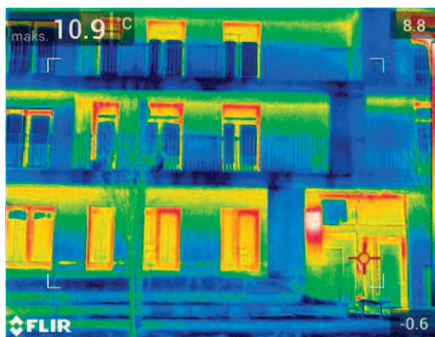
Zdjęcie termowizyjne elewacji południowo-wschodniej budynku D
